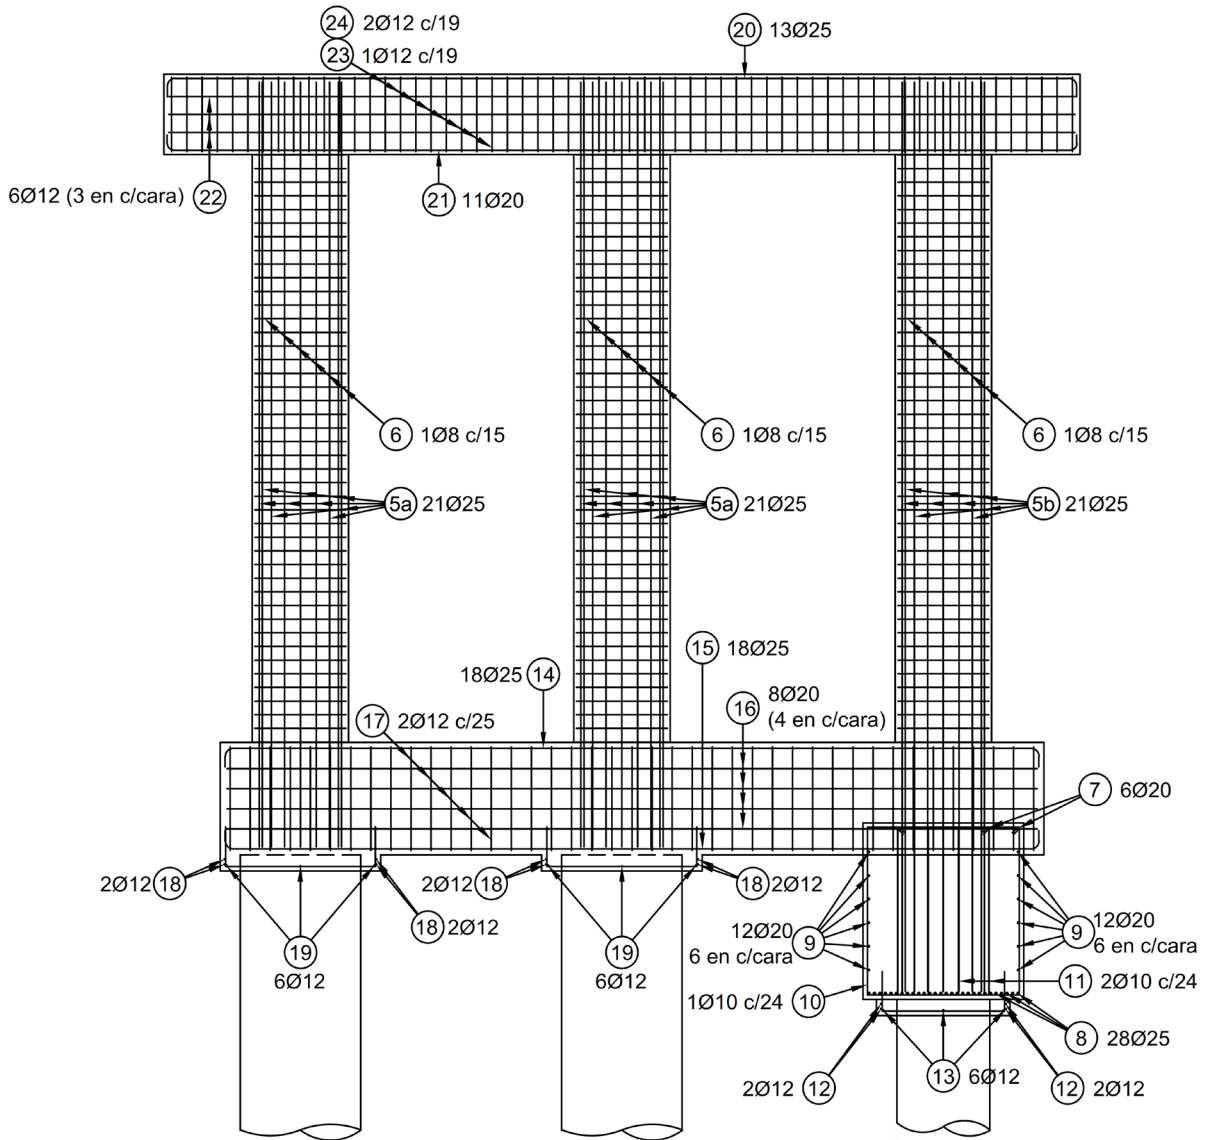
Detalles de armado en pila de Puente Ruta 40.
